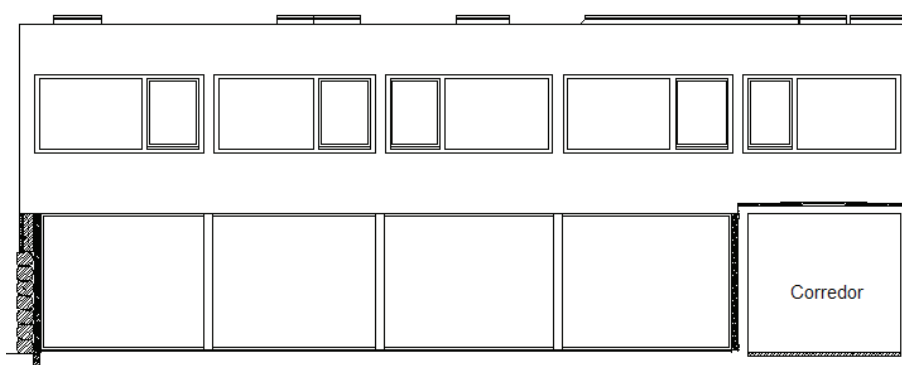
Fachada com envidraçados orientada a Sudoeste - Esquema.
